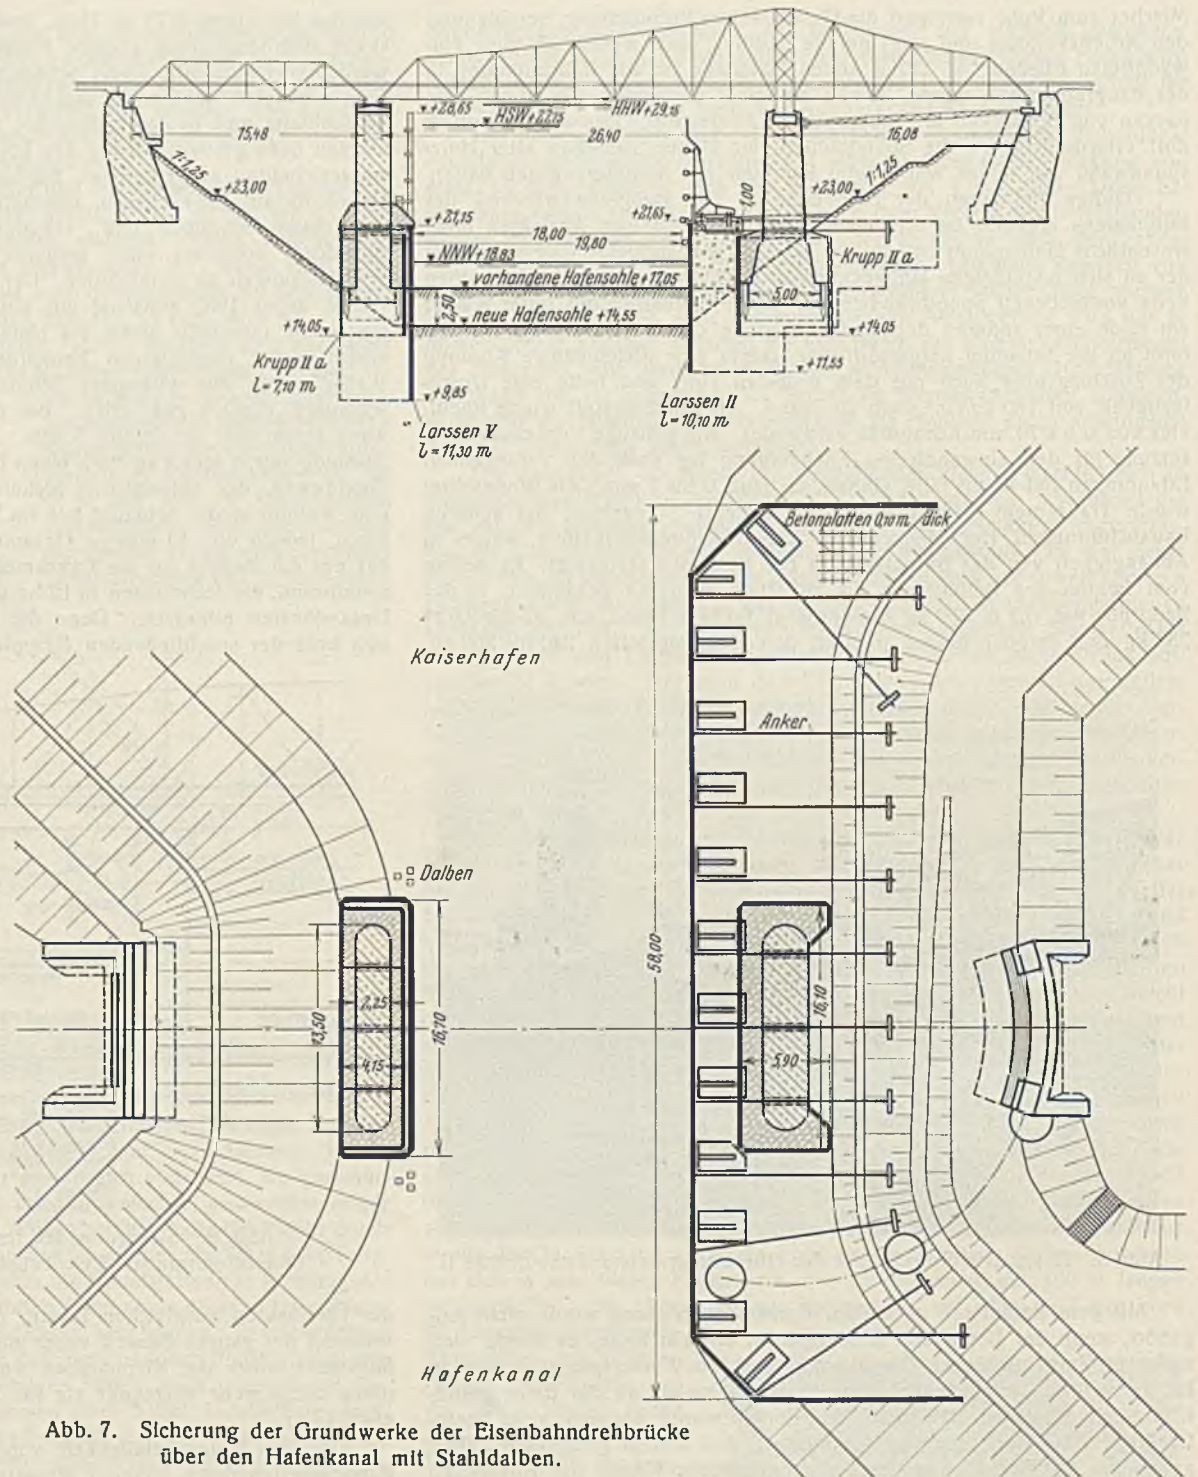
Sicherung der Grundwerke der Eisenbahndrehbrücke über den Hafenkanaal mit Stahldalben.
